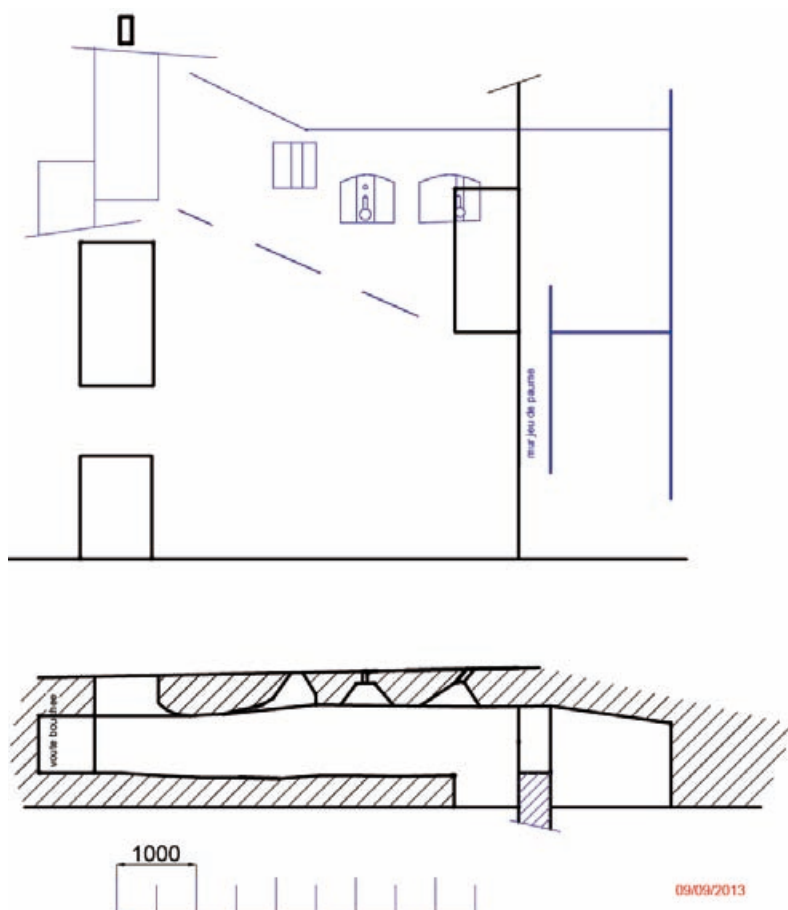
Elévation du passage intra-mural vers la salle du second étage. Dessin P. Lhomme.
